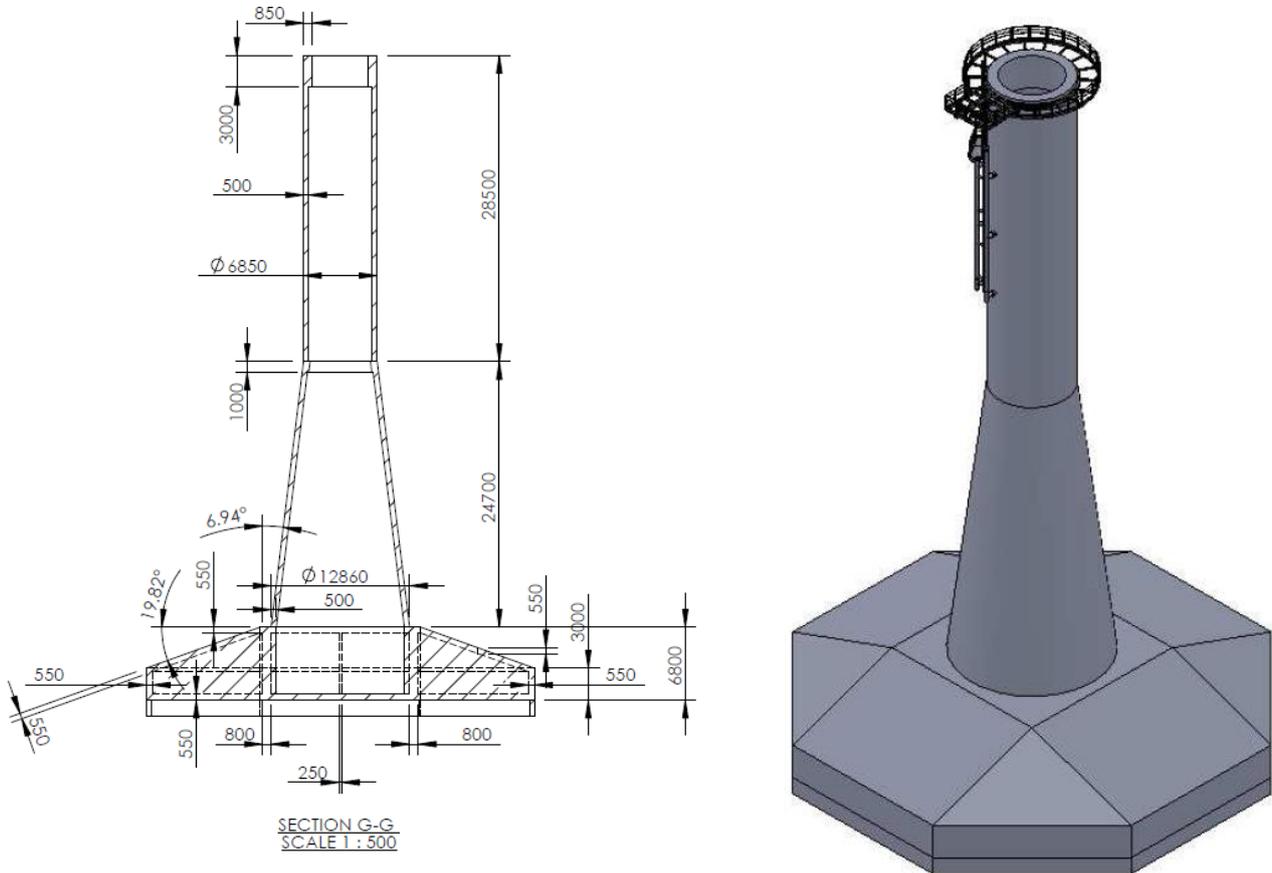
Plan en coupe et isométrie de fondation gravitaire, profondeur de 31,8 m / CM
